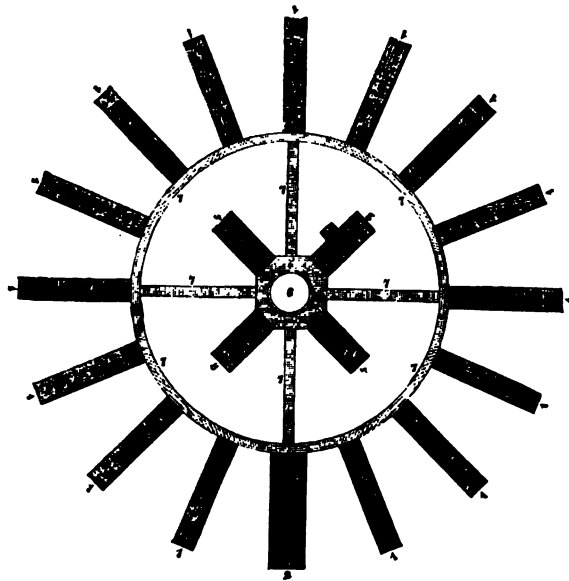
Fig. V. Grundriss des Sedgwick-General-Hospitals zu Greenville, La. (bei New-Orleans.)
